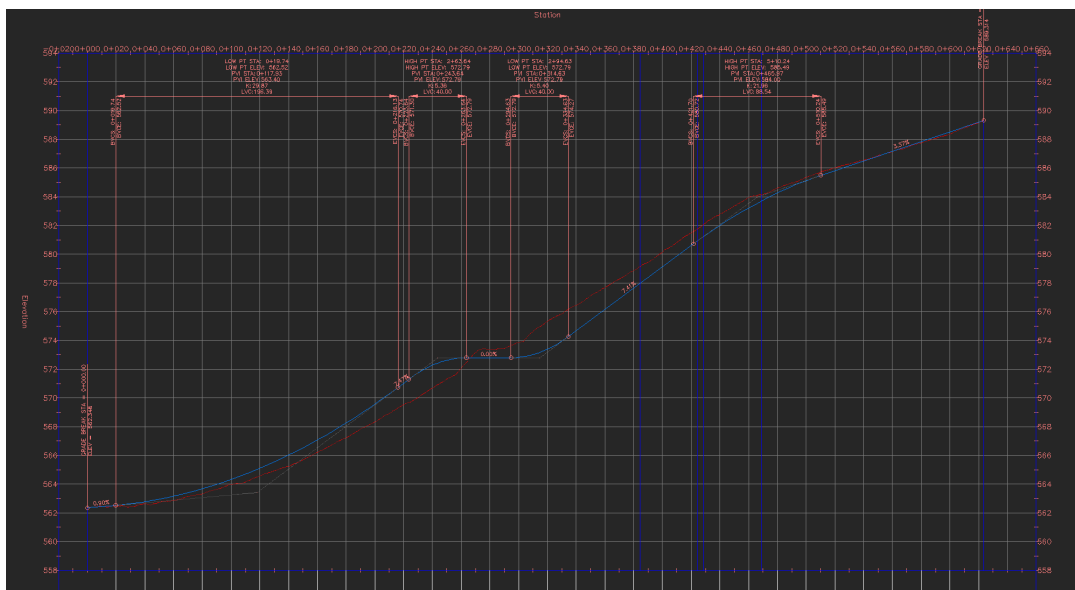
Alzado CV-653. Fuente: Elaboración propia.
